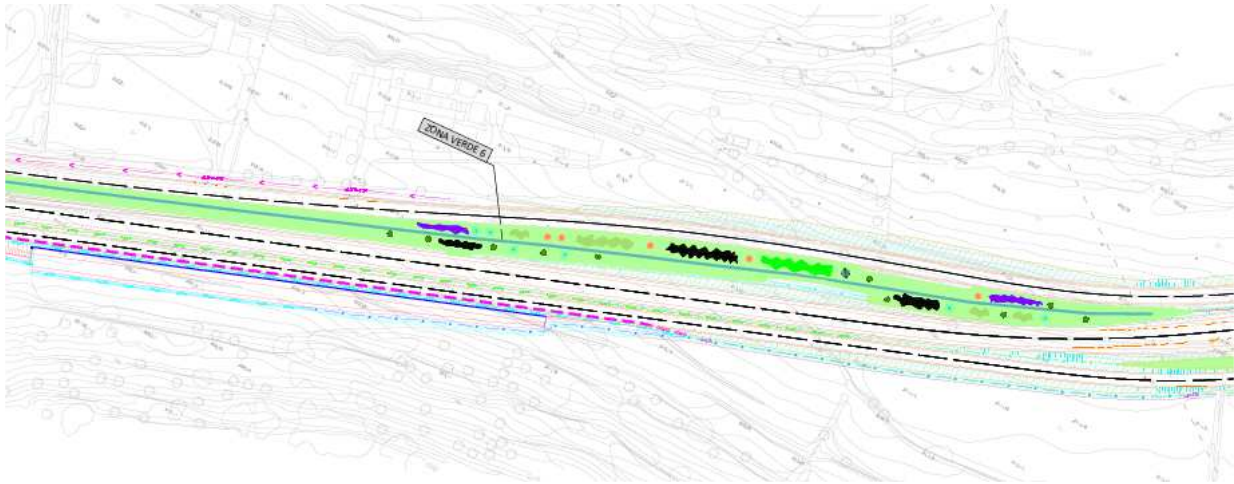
Zona 6 de revegetación. Fuente: Elaboración propia.
